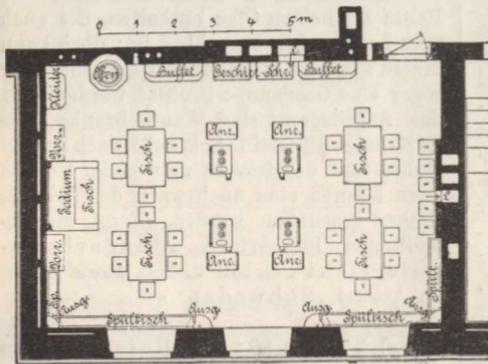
Grundriß einer Schulküche in München-Neuhausen.
